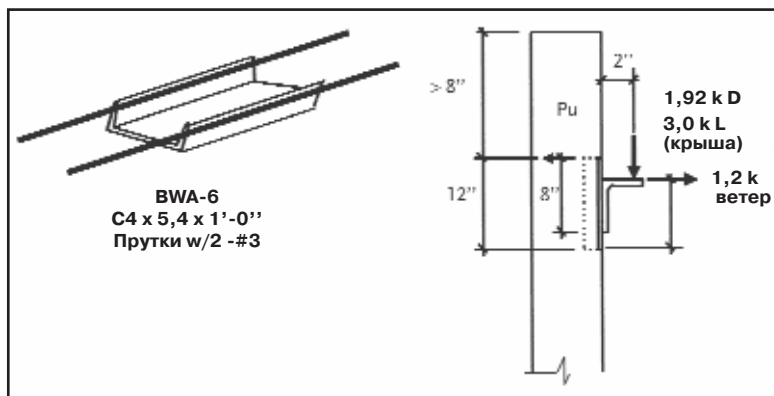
Конструкция верхнего соединительного узла, воспринимающего нагрузку.
